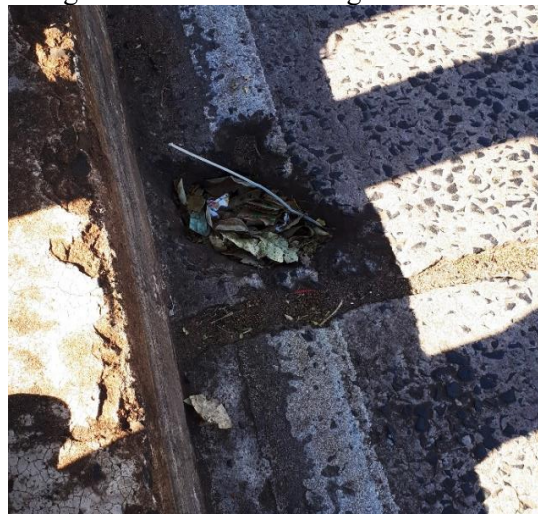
Junta de dilatação na faixa de rolamento de concreto
